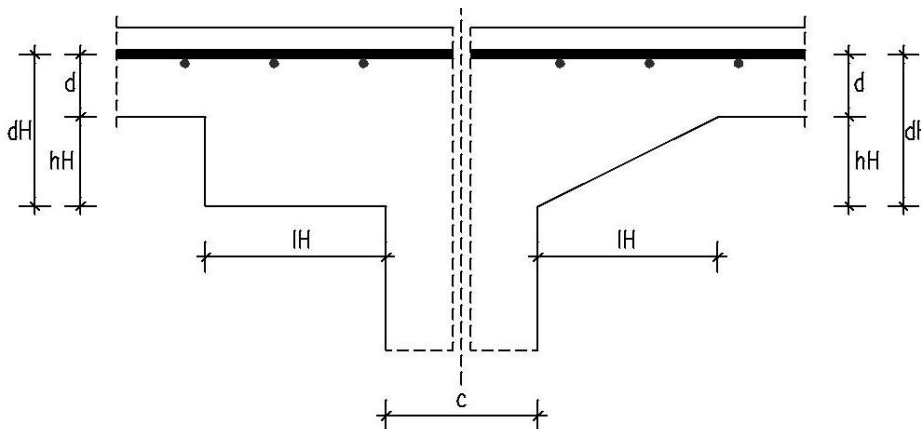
Laje sobre capitel que apoia sobre um pilar interior
